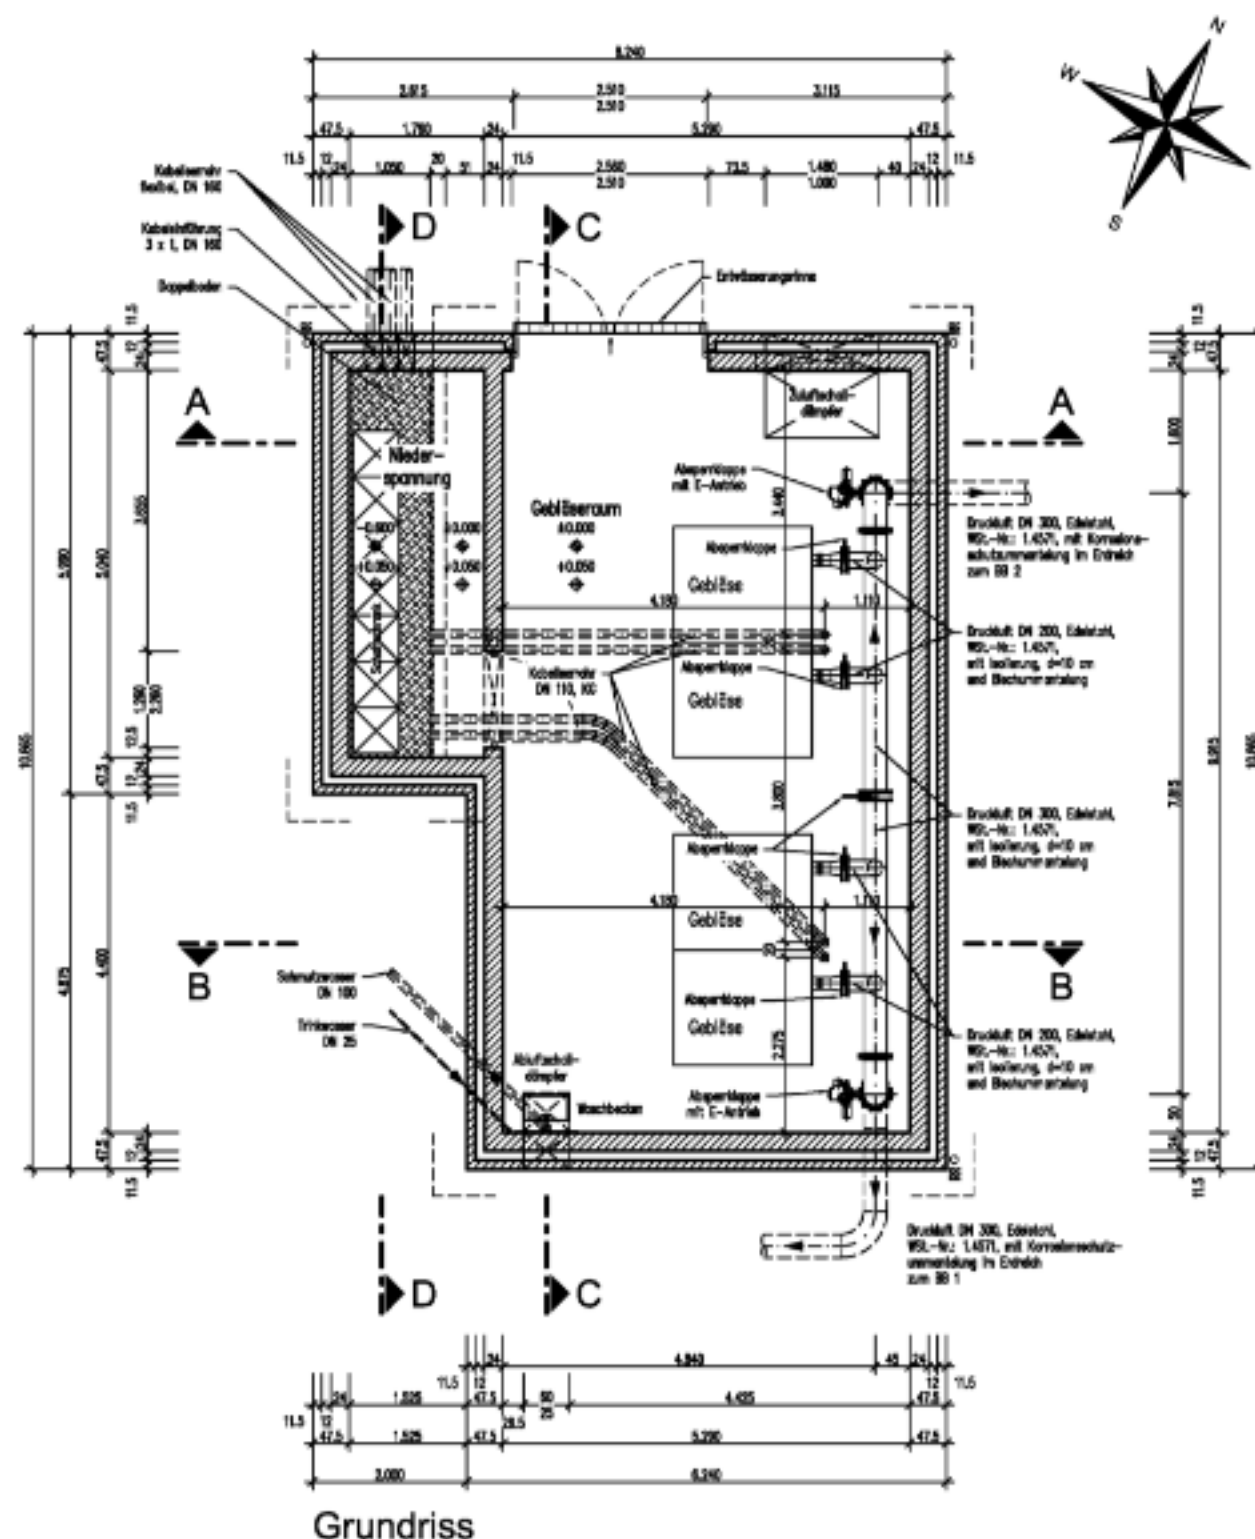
Grundriss der neuen Gebläsestation mit Aufstellung der Maschinentechnik
